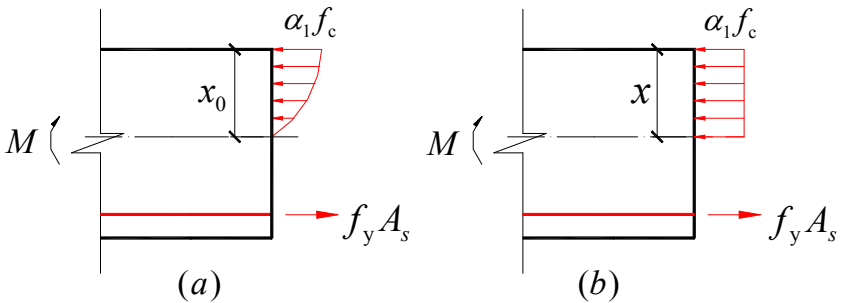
单筋矩形截面受压区混凝土等效应力图
